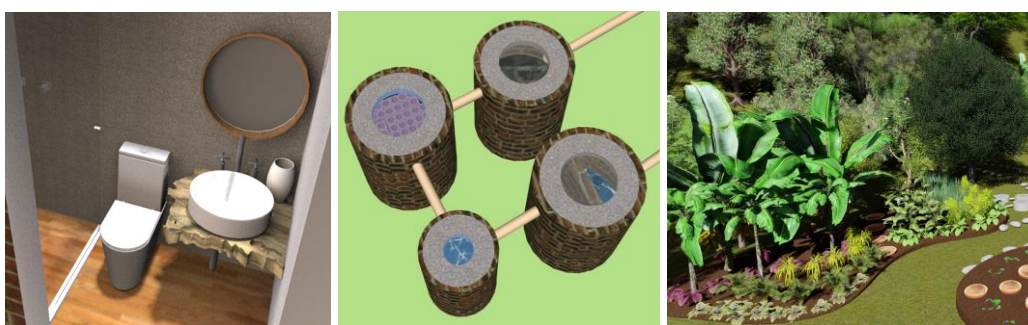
banheiro do primeiro pavimento (à esquerda) e sistema modular para o tratamento de esgoto. Fonte: elaborado pelos autores.
